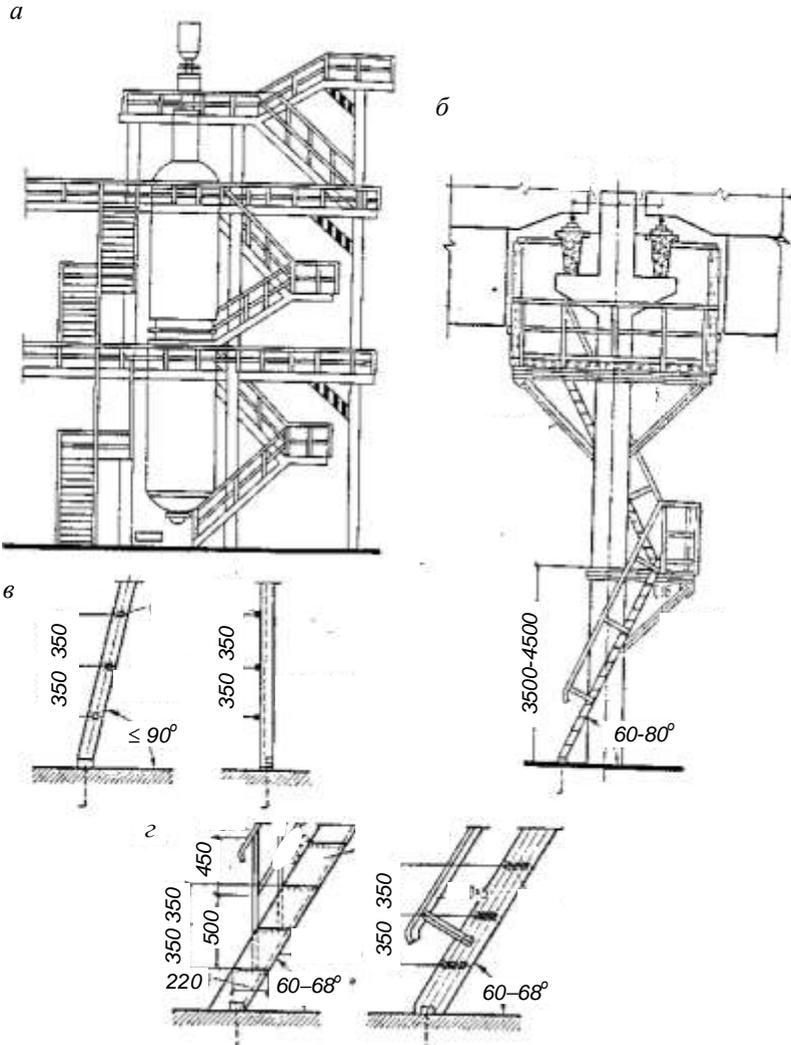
Служебная лестница: а — между рабочими площадками; б — на посадочную площадку на мостовые краны; в — конструкция стремянки; г — конструкция лестницы шириной 700–900 мм
